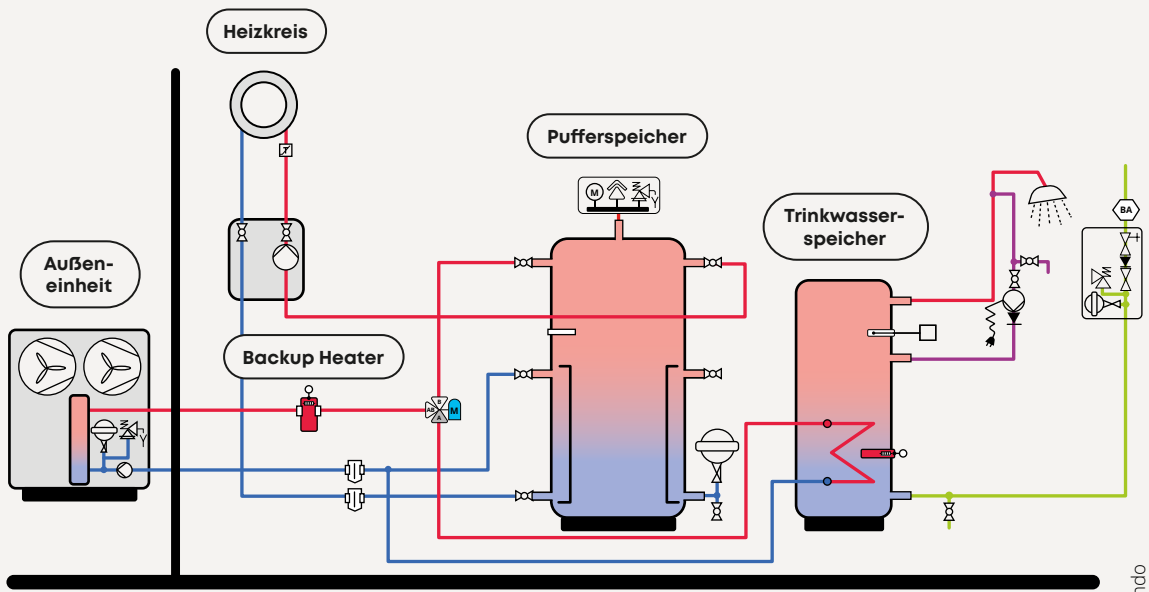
HYDRAULIKSCHEMA WÄRMEPUMPE MIT TRINKWASSERSPEICHER
